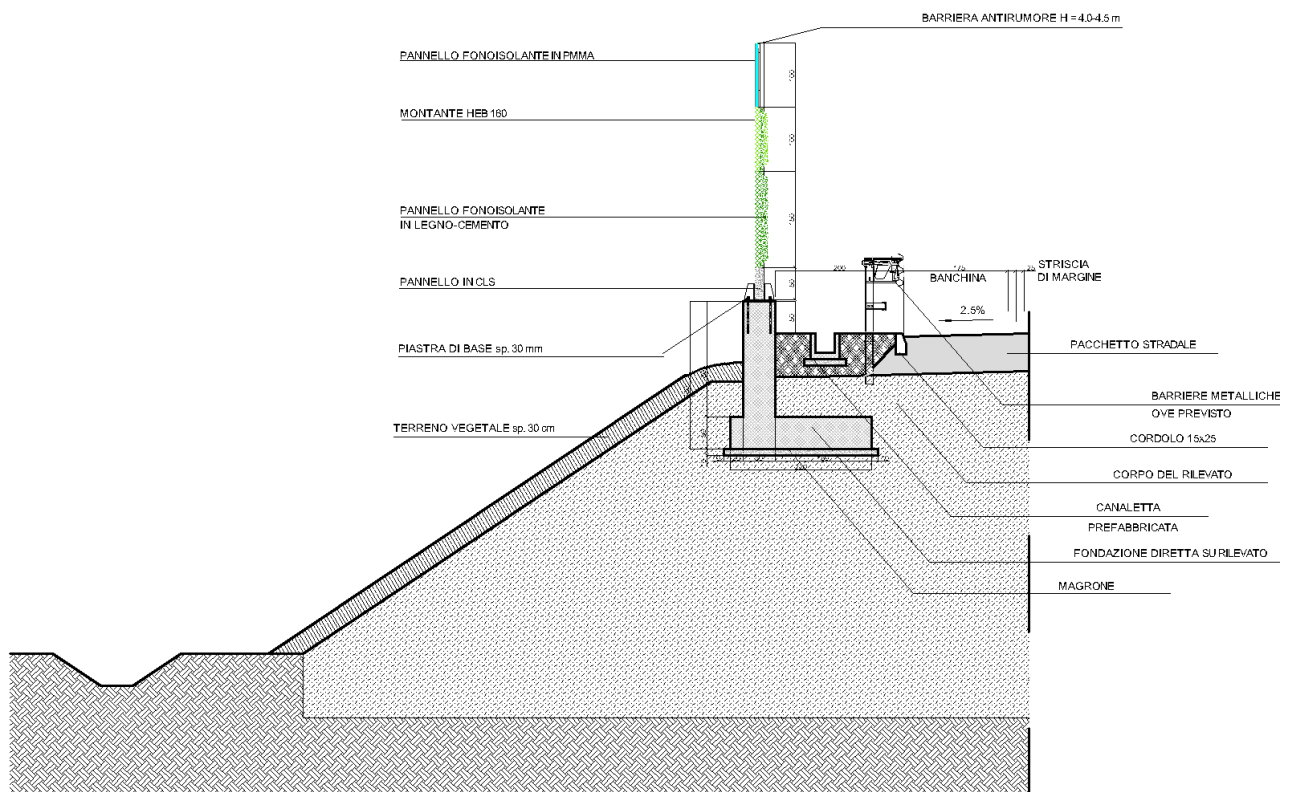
MURO BARRIERA CON FONDAZIONE SU RILEVATO
